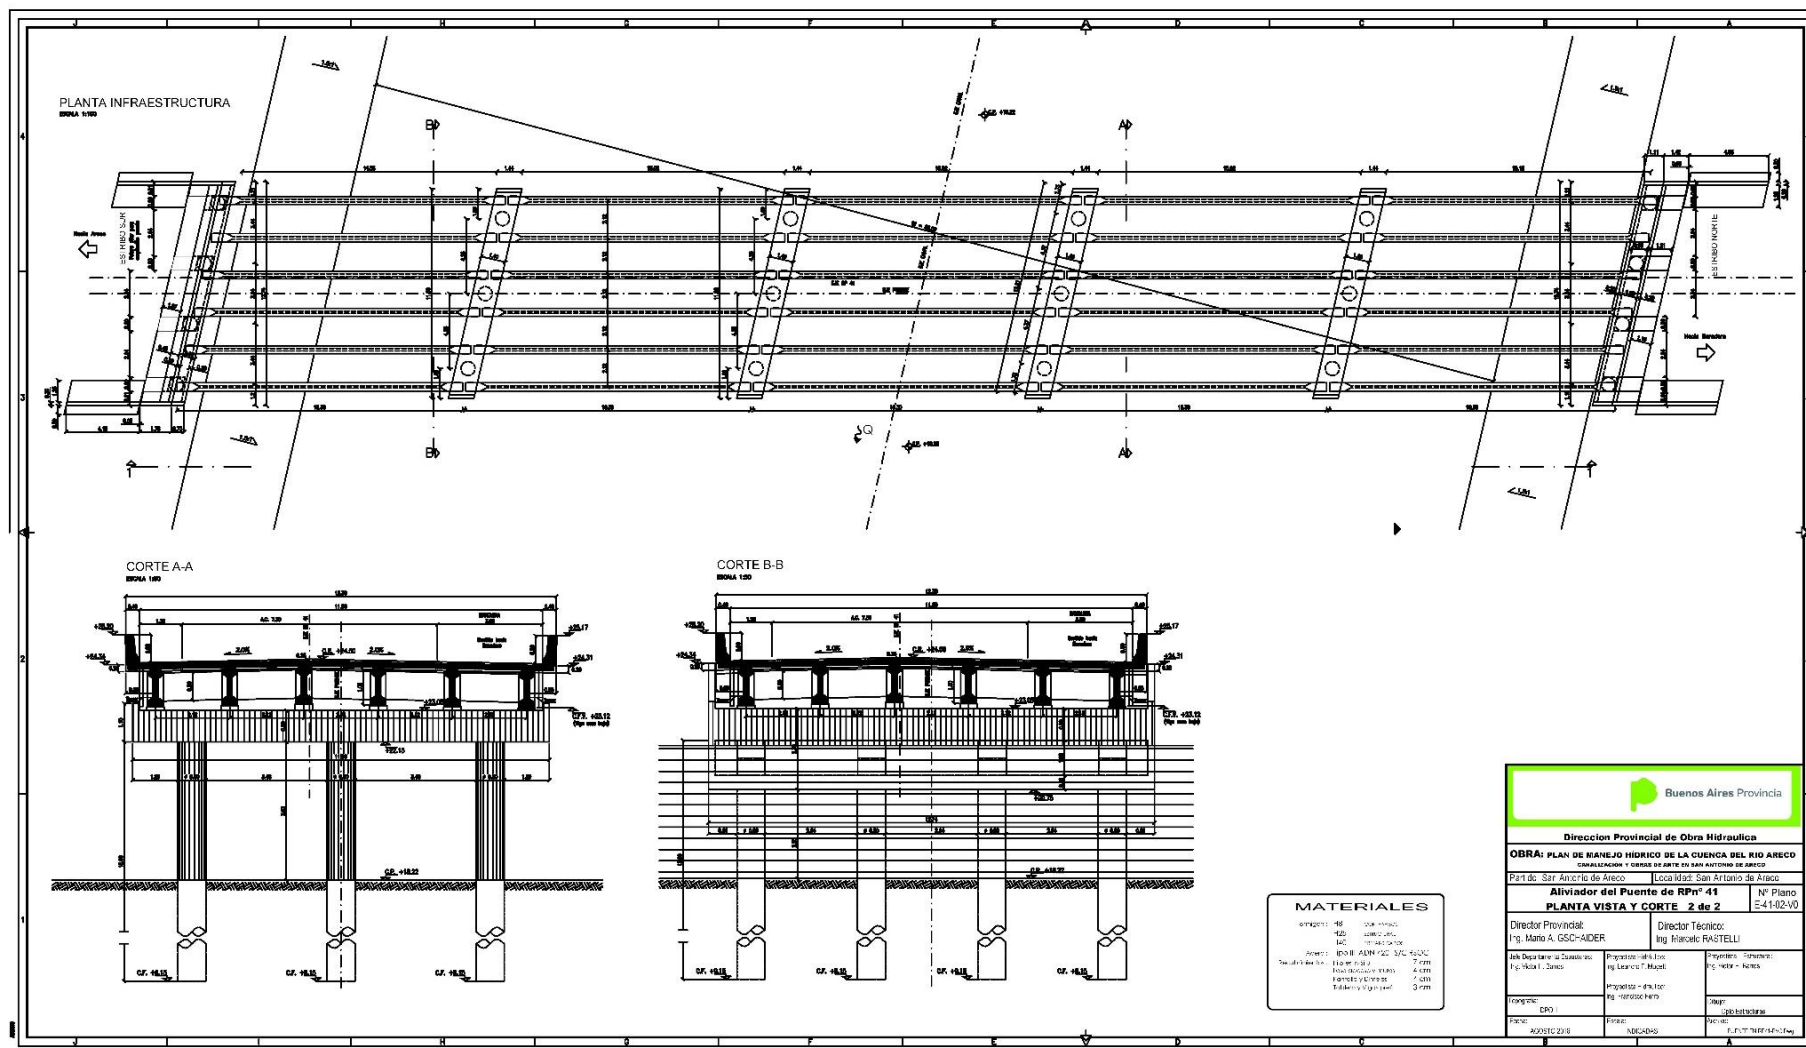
Aliviador de Puente de R.P. N° 41. Planta, Vista y Corte (2/2)
